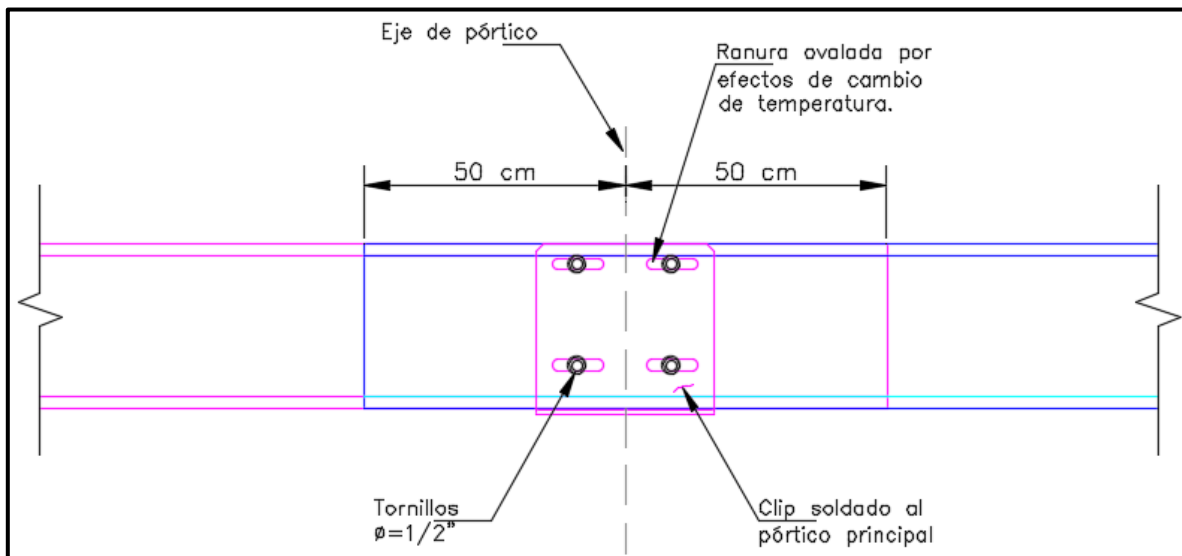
Traslape de perfiles ZF, vista lateral (autoría propia, 2021).
